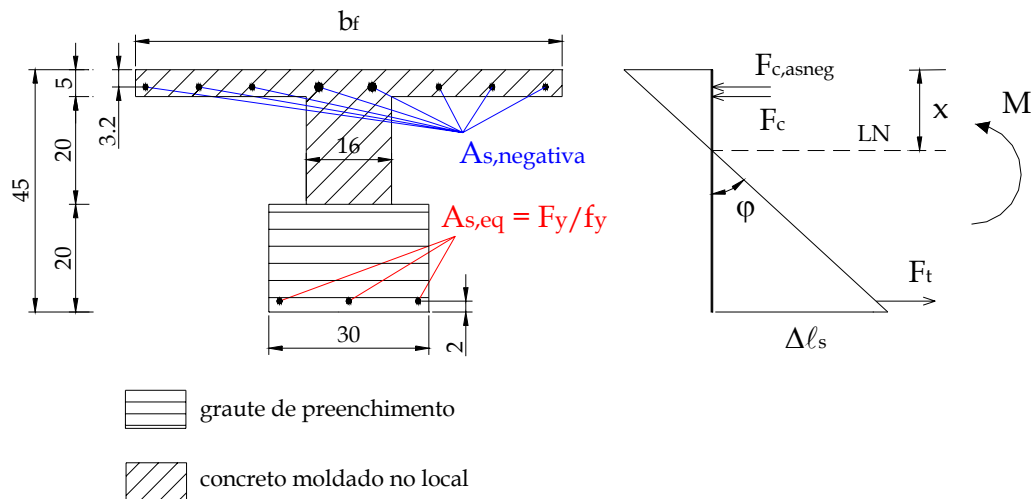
Seção de concreto considerada (dimensões em cm).
